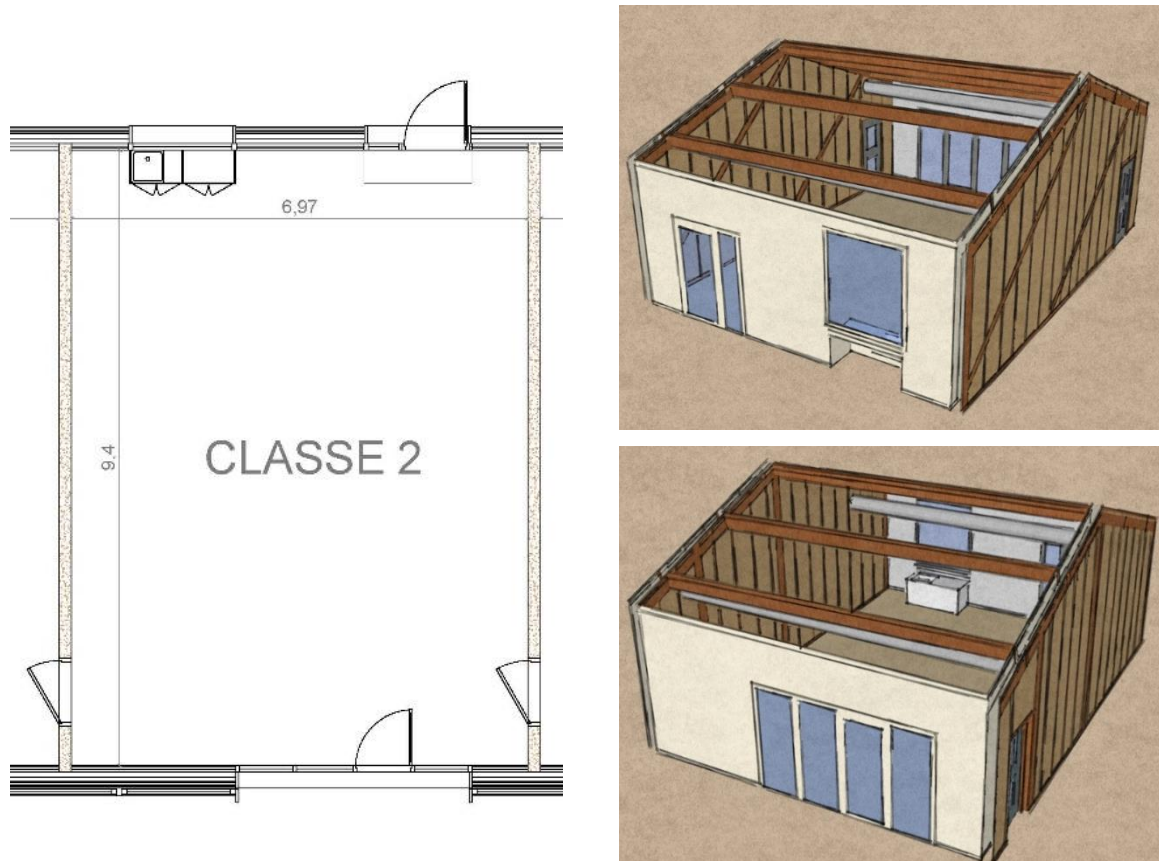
Plan courant de la salle de classe et vue 3D – Baulon.
